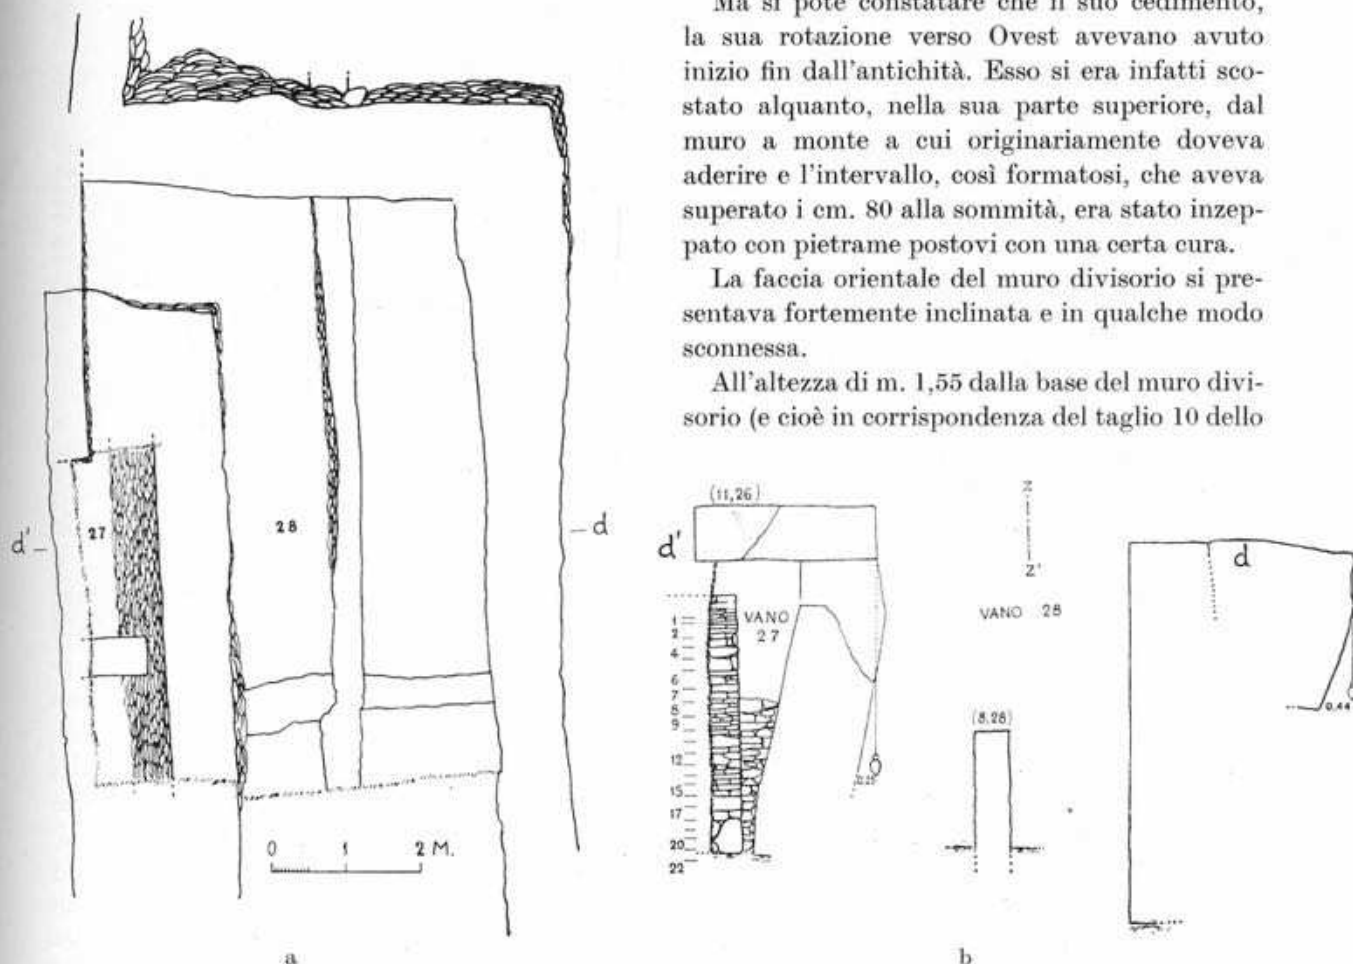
IL VANO 27 APPARSO A MONTE DEL VANO 28 DOPO IL CROLLO DEL MURO DIVISORIO. PLANIMETRIA E SEZIONE.
